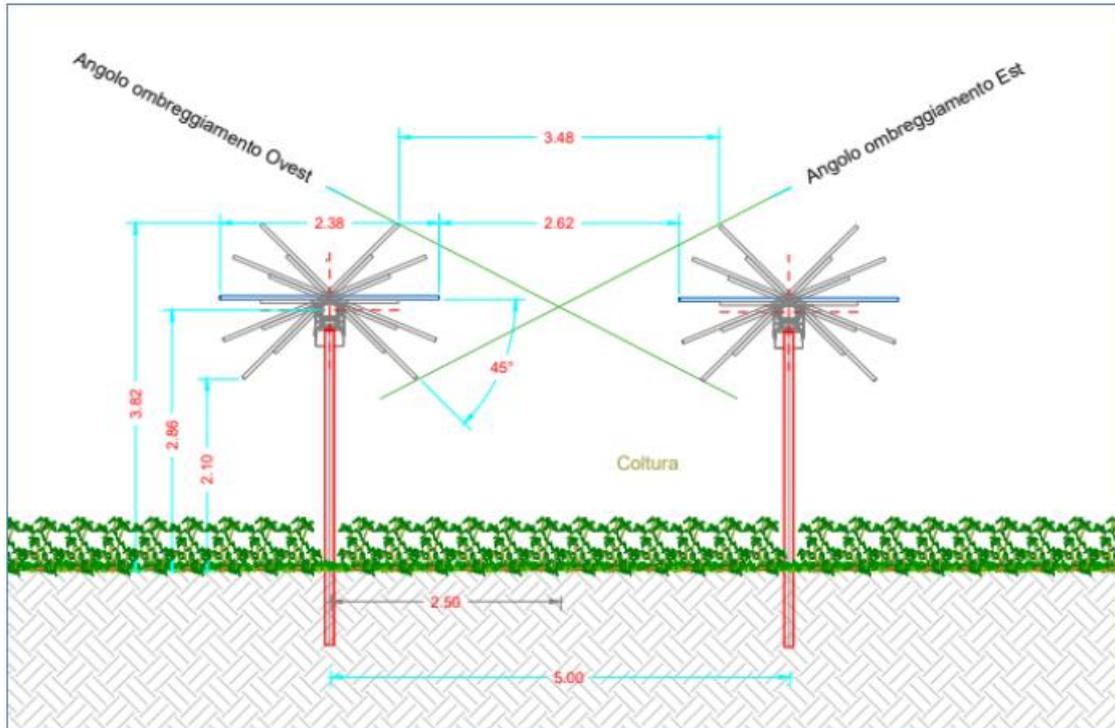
Sezione trasversale tipologica struttura Tracker con erbaio
